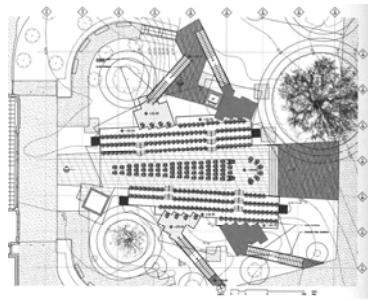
Planta, pavilhão de Frank O. Gehry, 2008.
